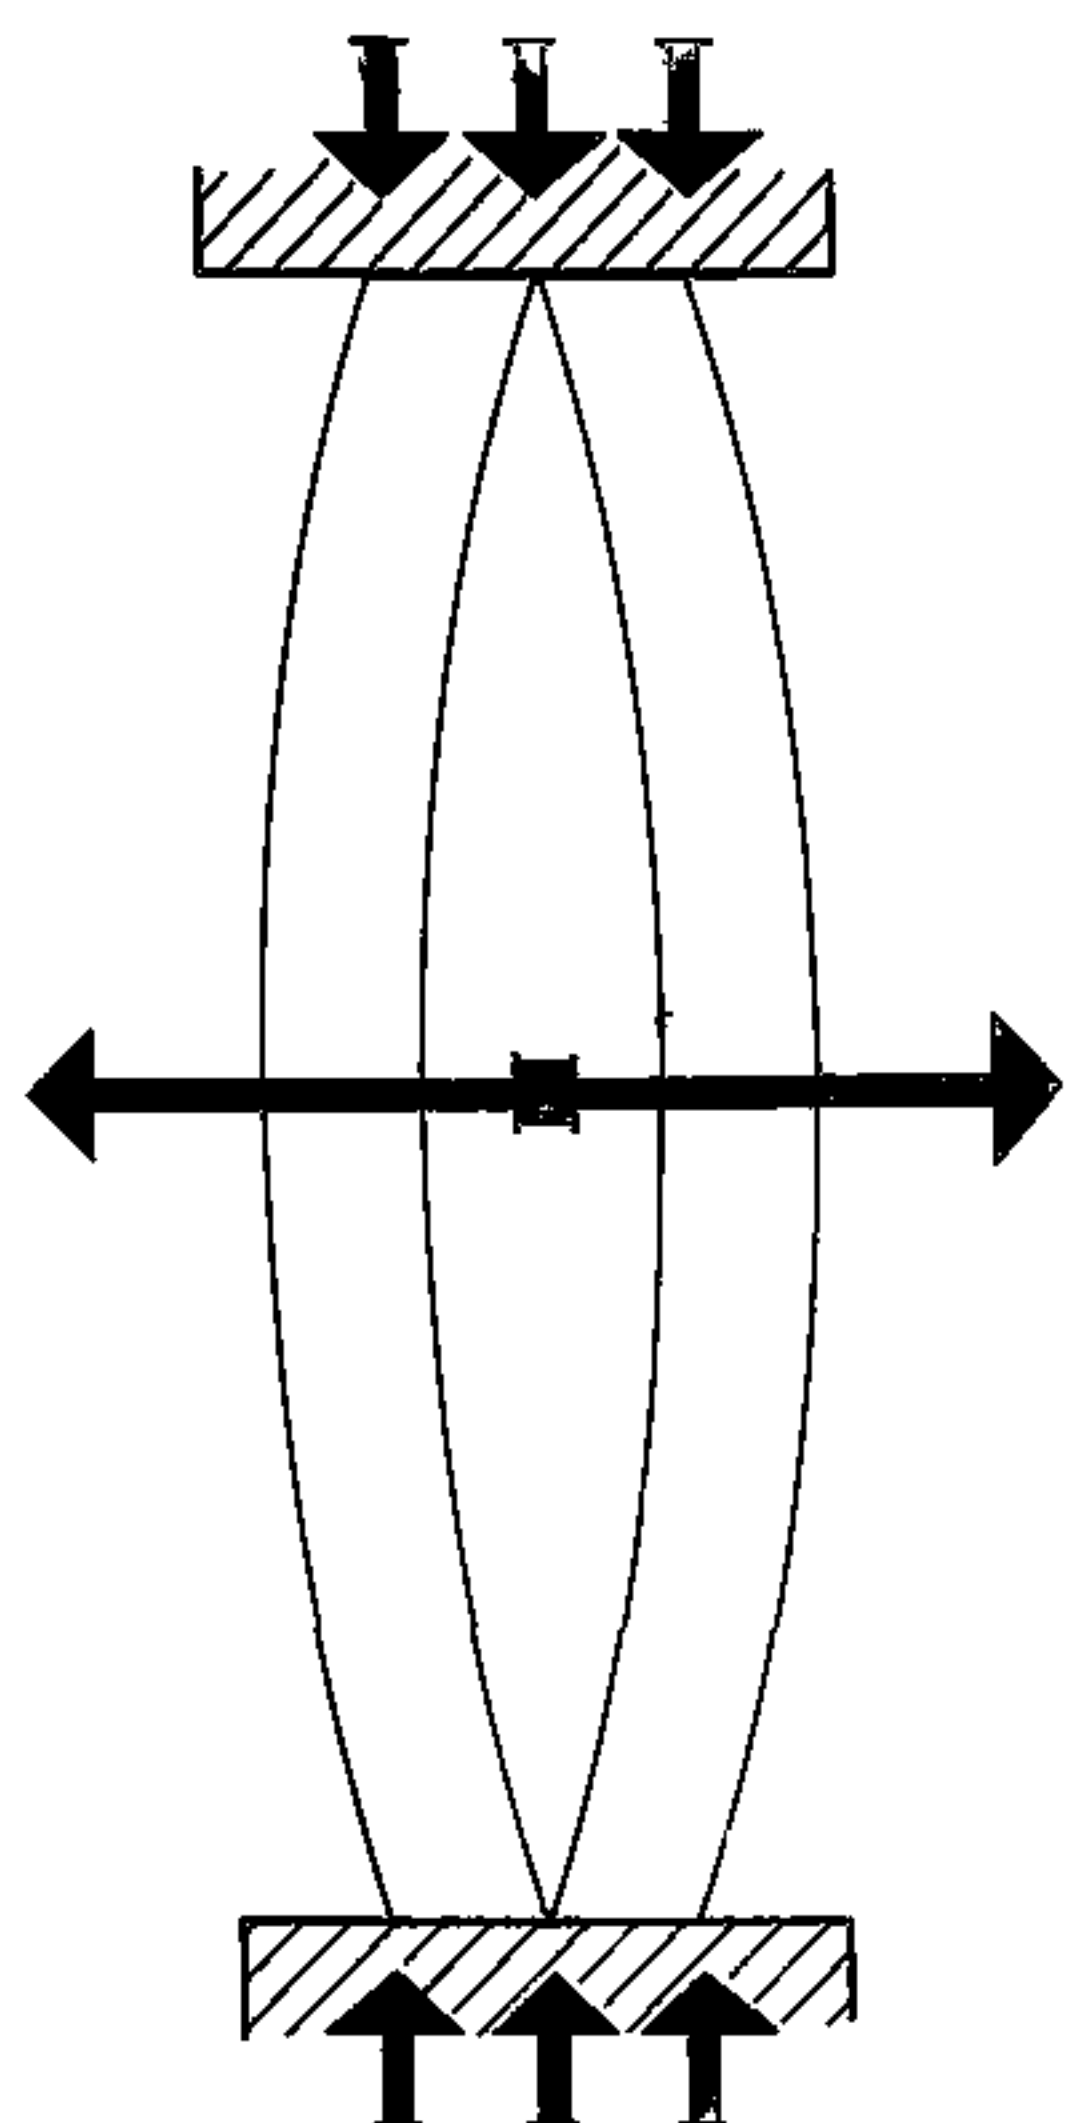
Схема расщепления колонн под вертикальной нагрузкой
